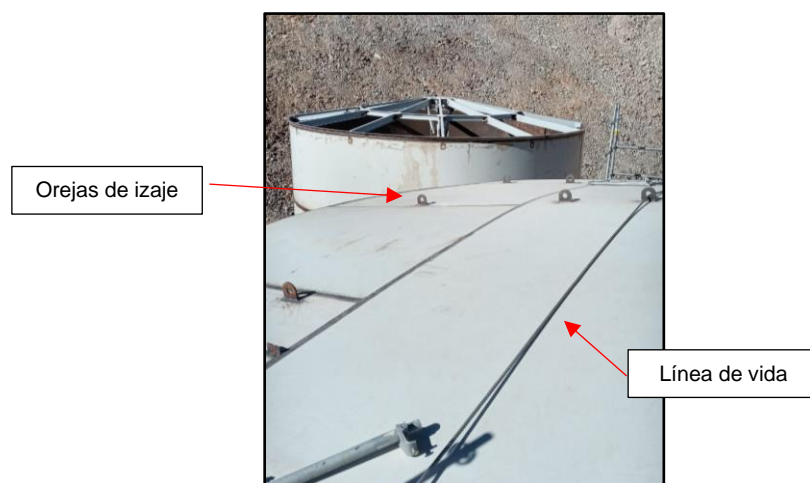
Segmentos 03 y 02 posicionados y apuntalados sobre estructura de soporte de techo.
